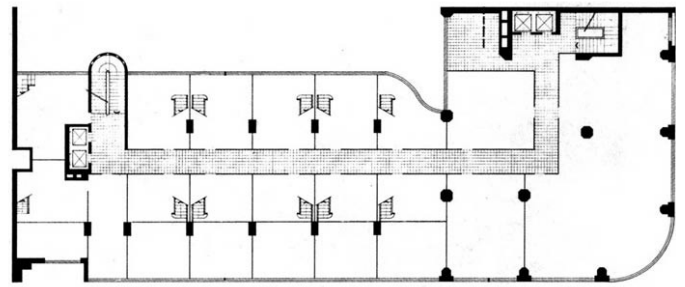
Planimetría del edificio Oberpaur. Fuente de: plataformaarquitectura.cl
